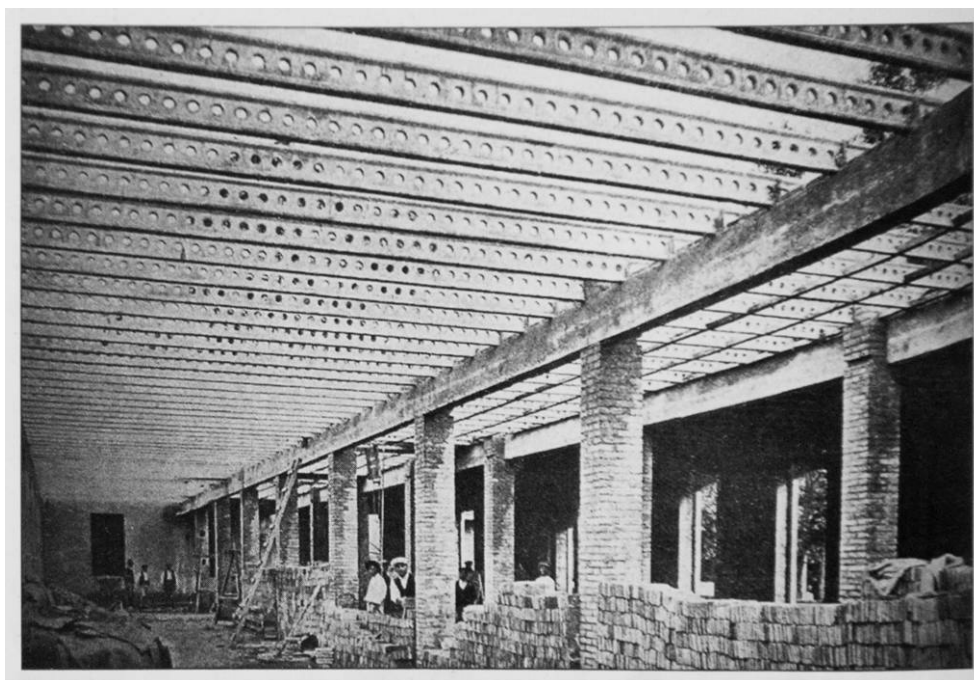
Construcción de un forjado con viguetas Leo en la Casa de la Salud de Valencia. 1917
